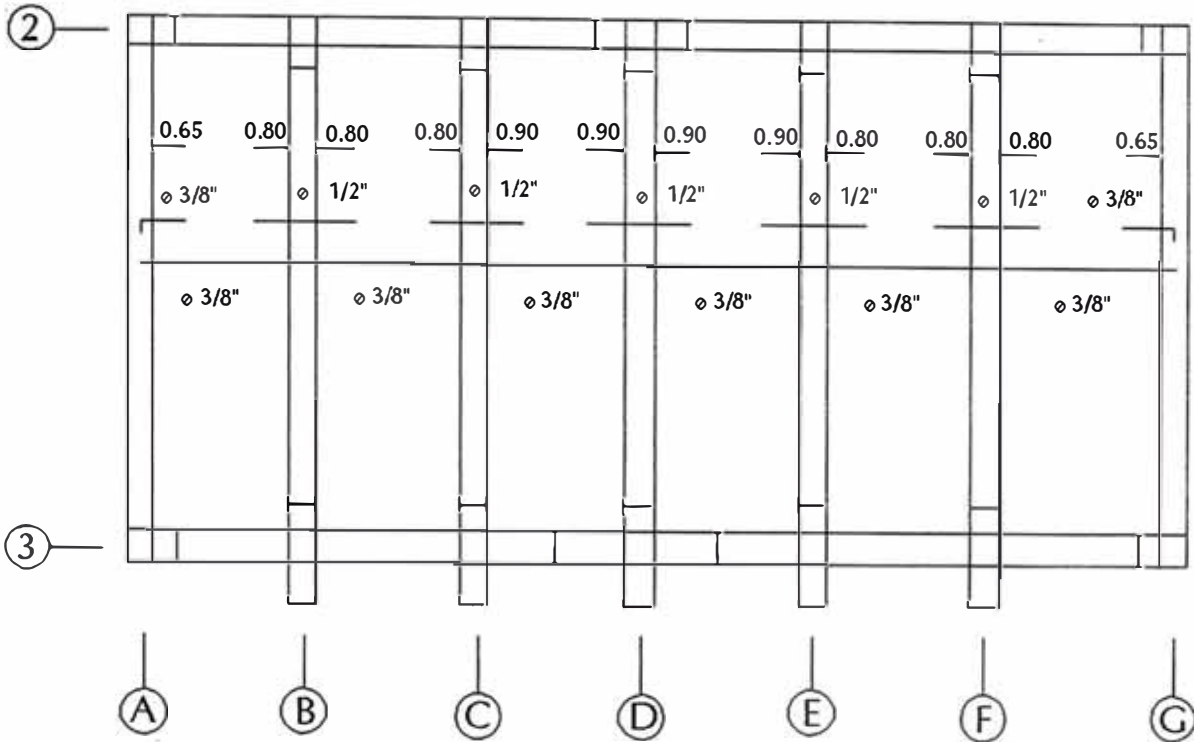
Refuerzo de la losa aligerada en toda su planta
